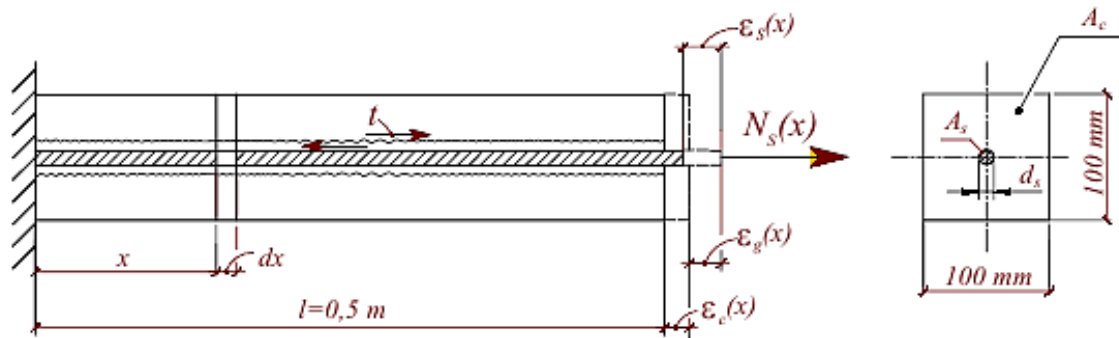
Расчетная схема элемента характерного железобетонного элемента
